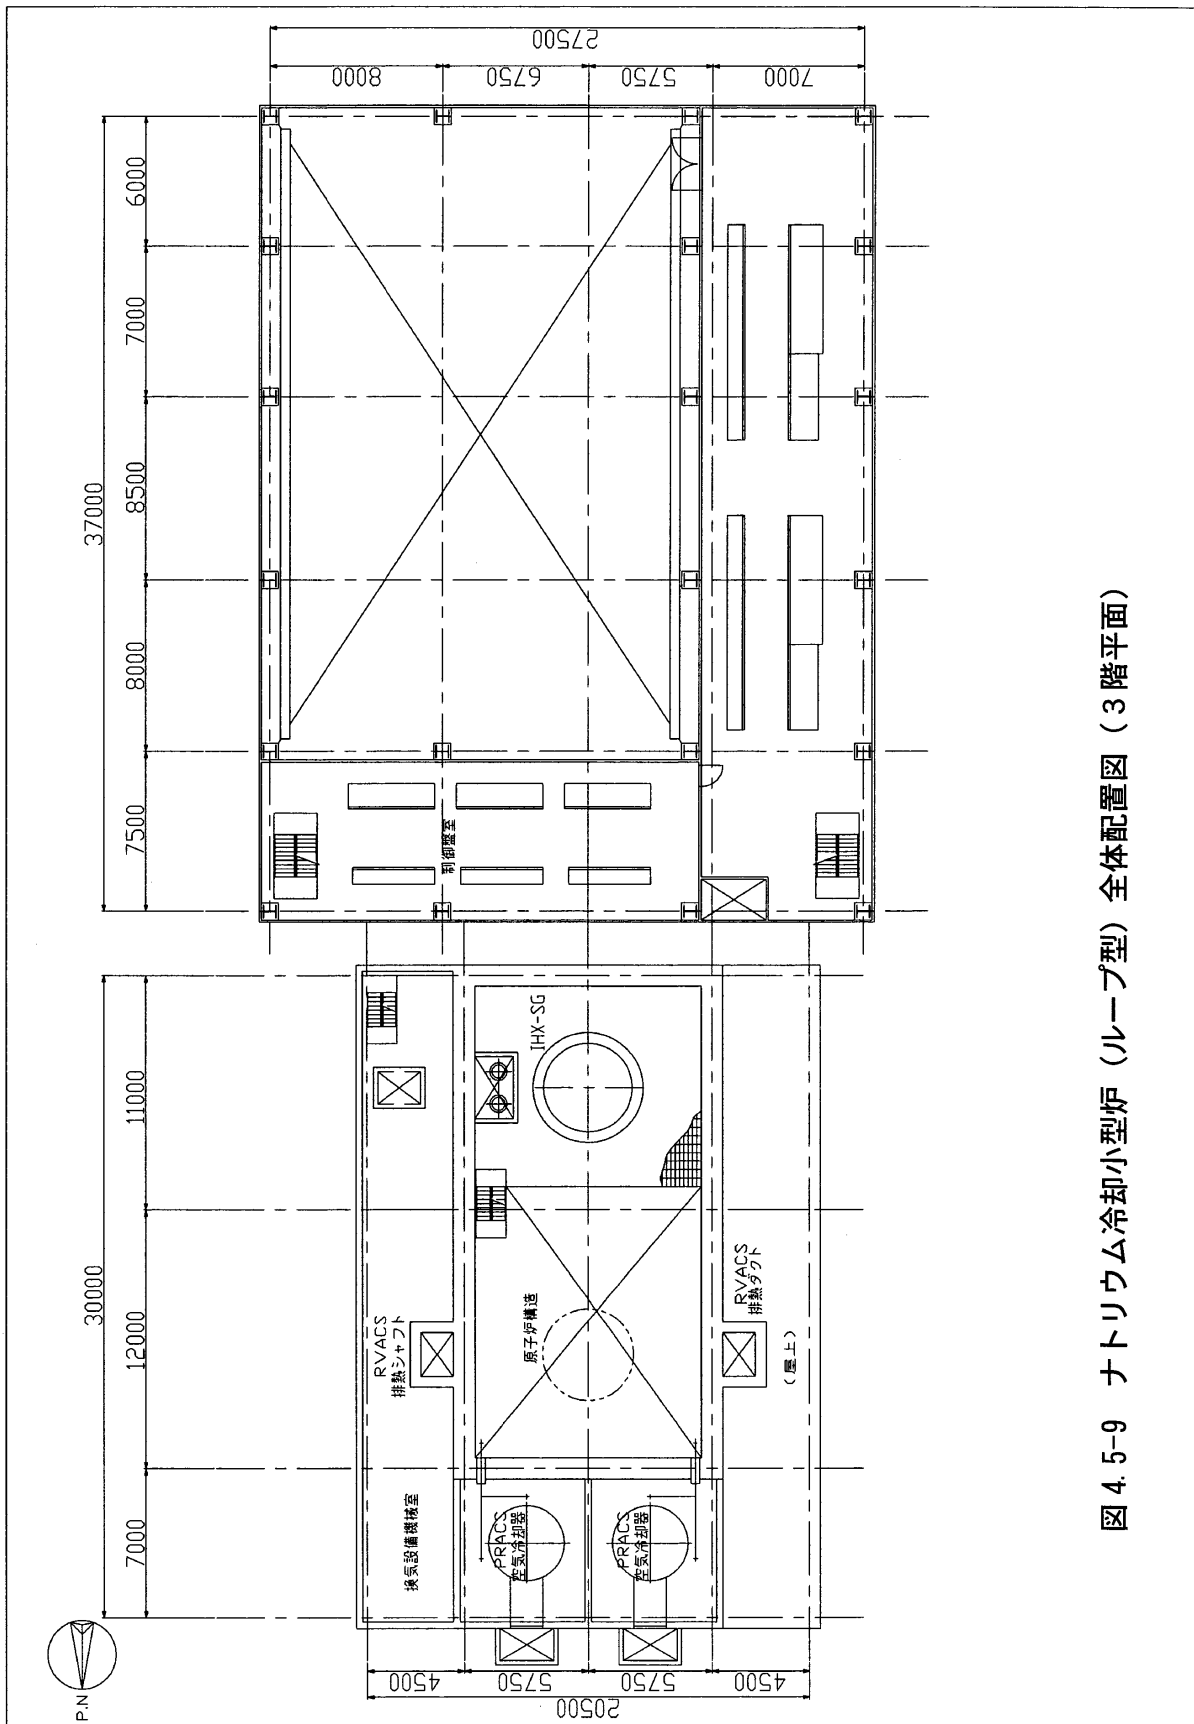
ナトリウム冷却小型炉（ループ型）全体配置図（3階平面）
